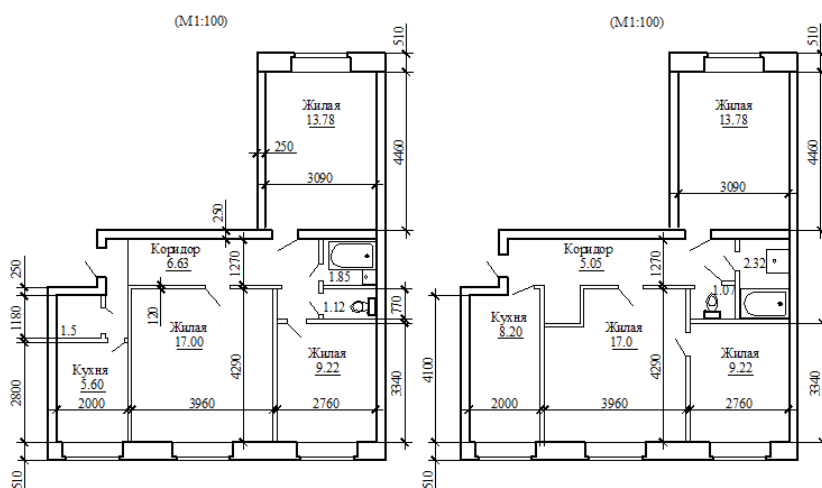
Вариант перепланировки трехкомнатной квартиры по ул. Рогачевской
